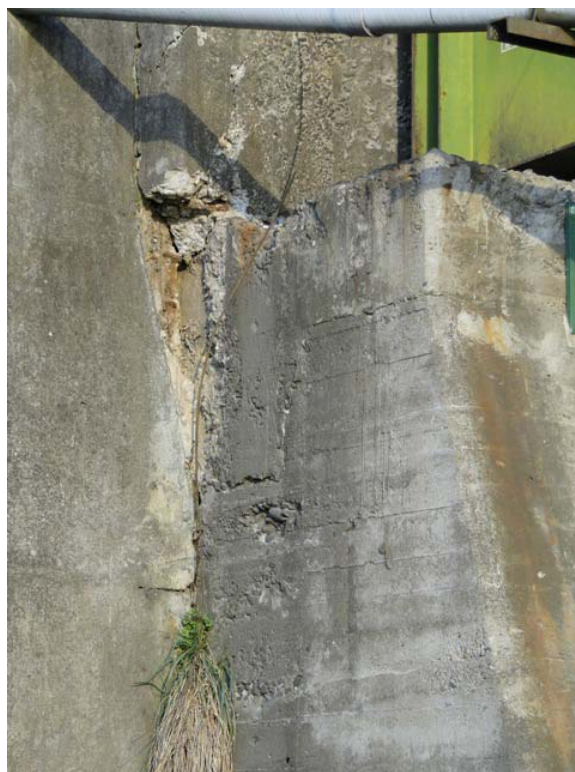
A 1 橋台上流側ひび割れ部
